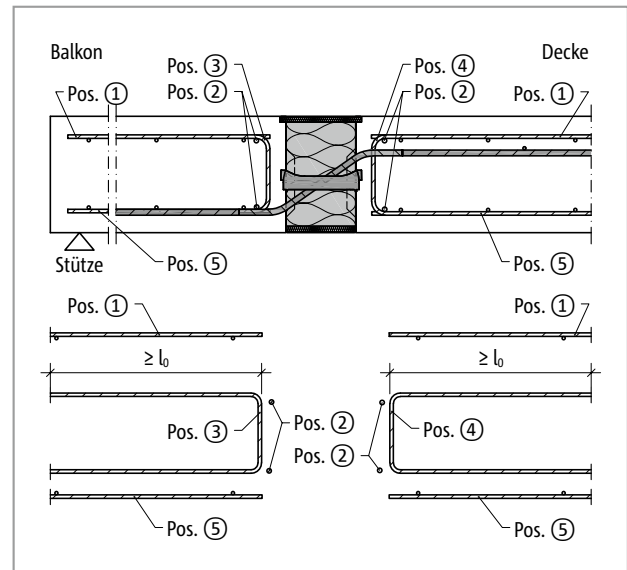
Schöck Isokorb® XT Typ Q-V5 bis Q-V11: Bauseitige Bewehrung
